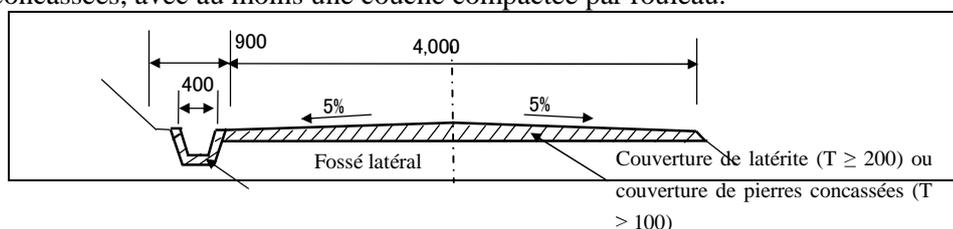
Coupe standard de la piste rurale (R1)
